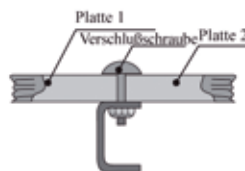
Schmäler Querträger. Befestigungsschraube in der Plattenfuge.
